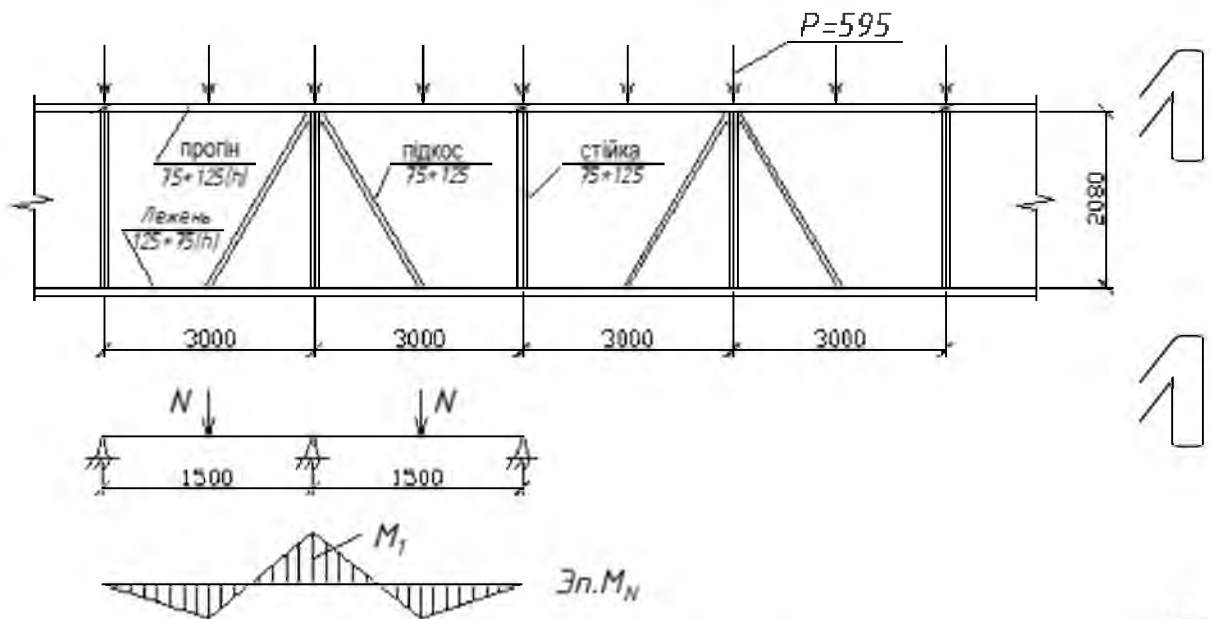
Конструктивна схема поздовжньої рами, епюра M верхнього пояса (прогону)
